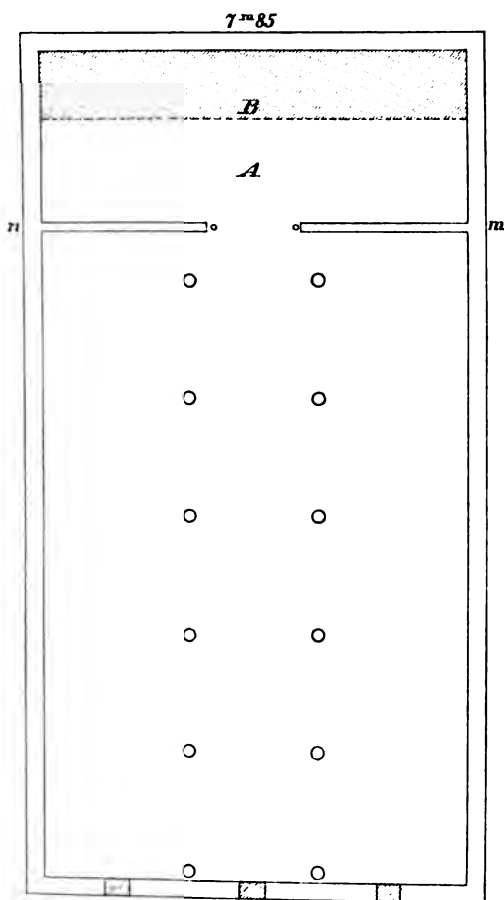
Grundriss der Basilika II in Hydra.
